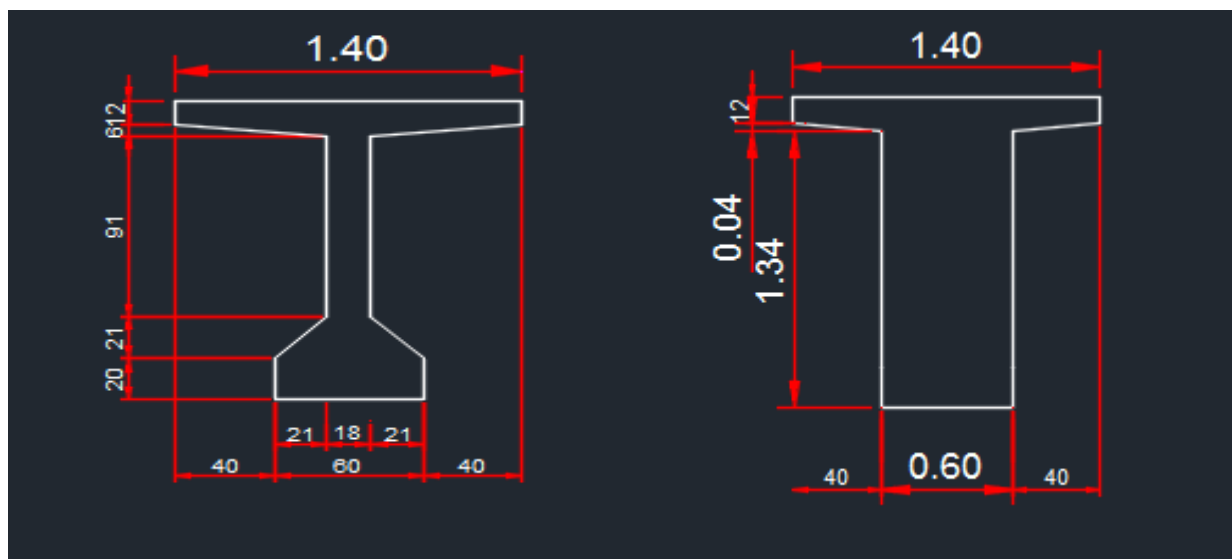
détail d'une poutre en post tension (section médiane + section d'about).
